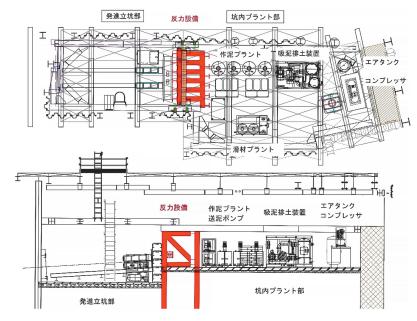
発進立坑および坑内プラント設備設置状況(上:平面・下:断面)
